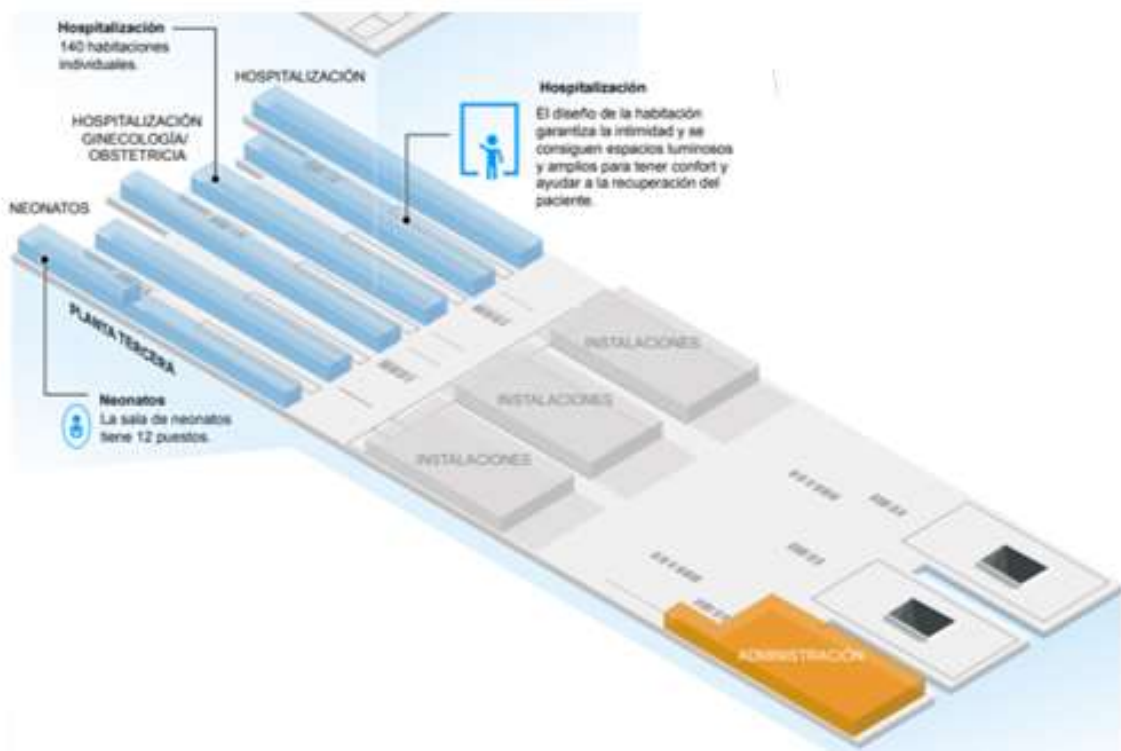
Esquema de las zonas del hospital 3ra y 4ta planta
